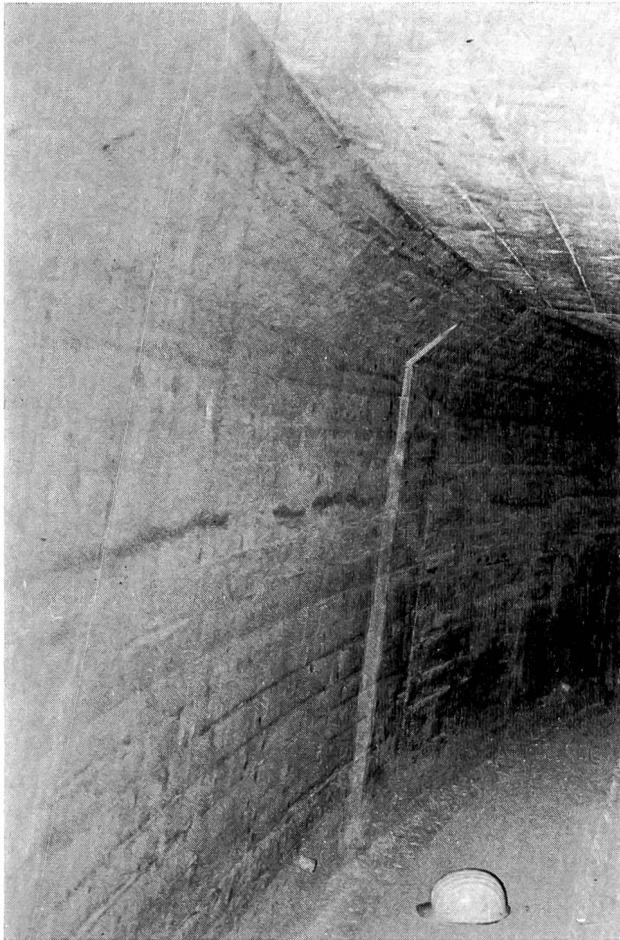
Kontrollgang im Betonfundament unter dem Reaktorgebäude; links unten Rinne und Rohrverbindung zum Sickerbeton.
